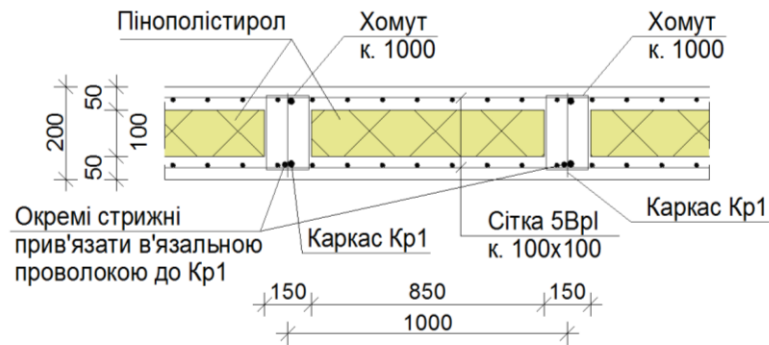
Схема армування пустотілого монолітного з / б перекриття з односпрямованими ребрами
